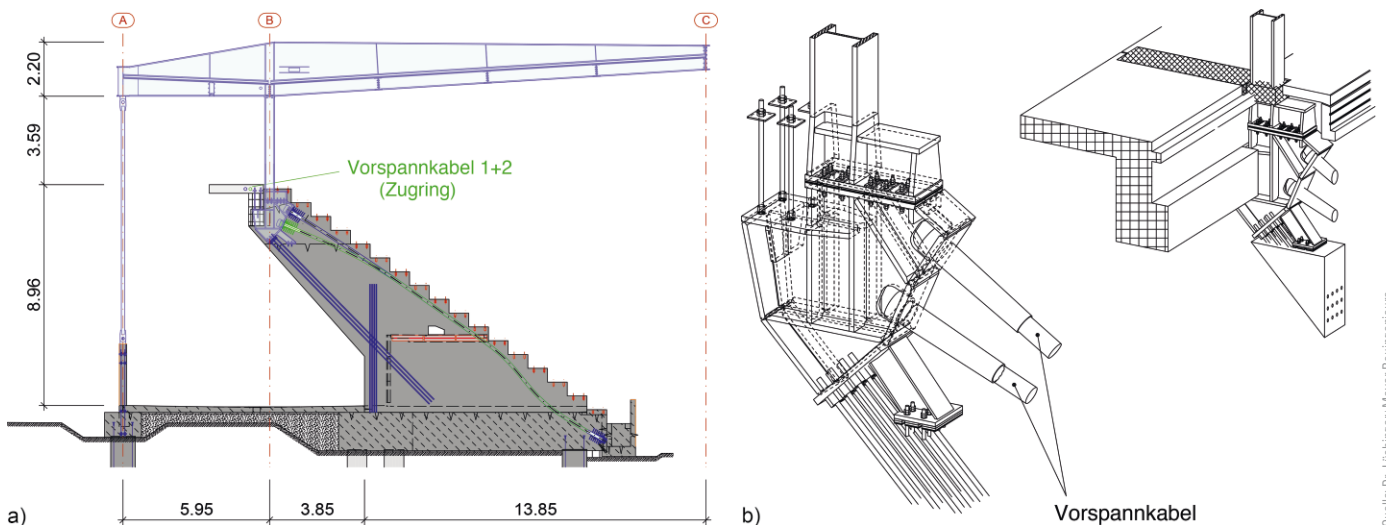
Vertikale Ortbetonwandscheibe der Tribünen: a) Querschnitt, b) Stahleinbauteil (Axonometrie)
